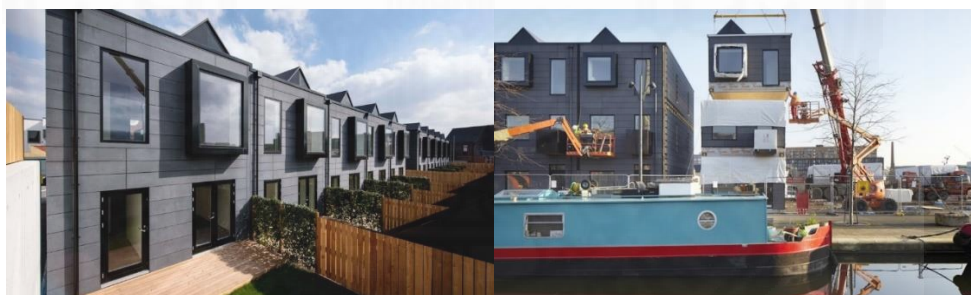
Drawing Y Cube London. Photo by Courtesy of New London Architecture, 2014
